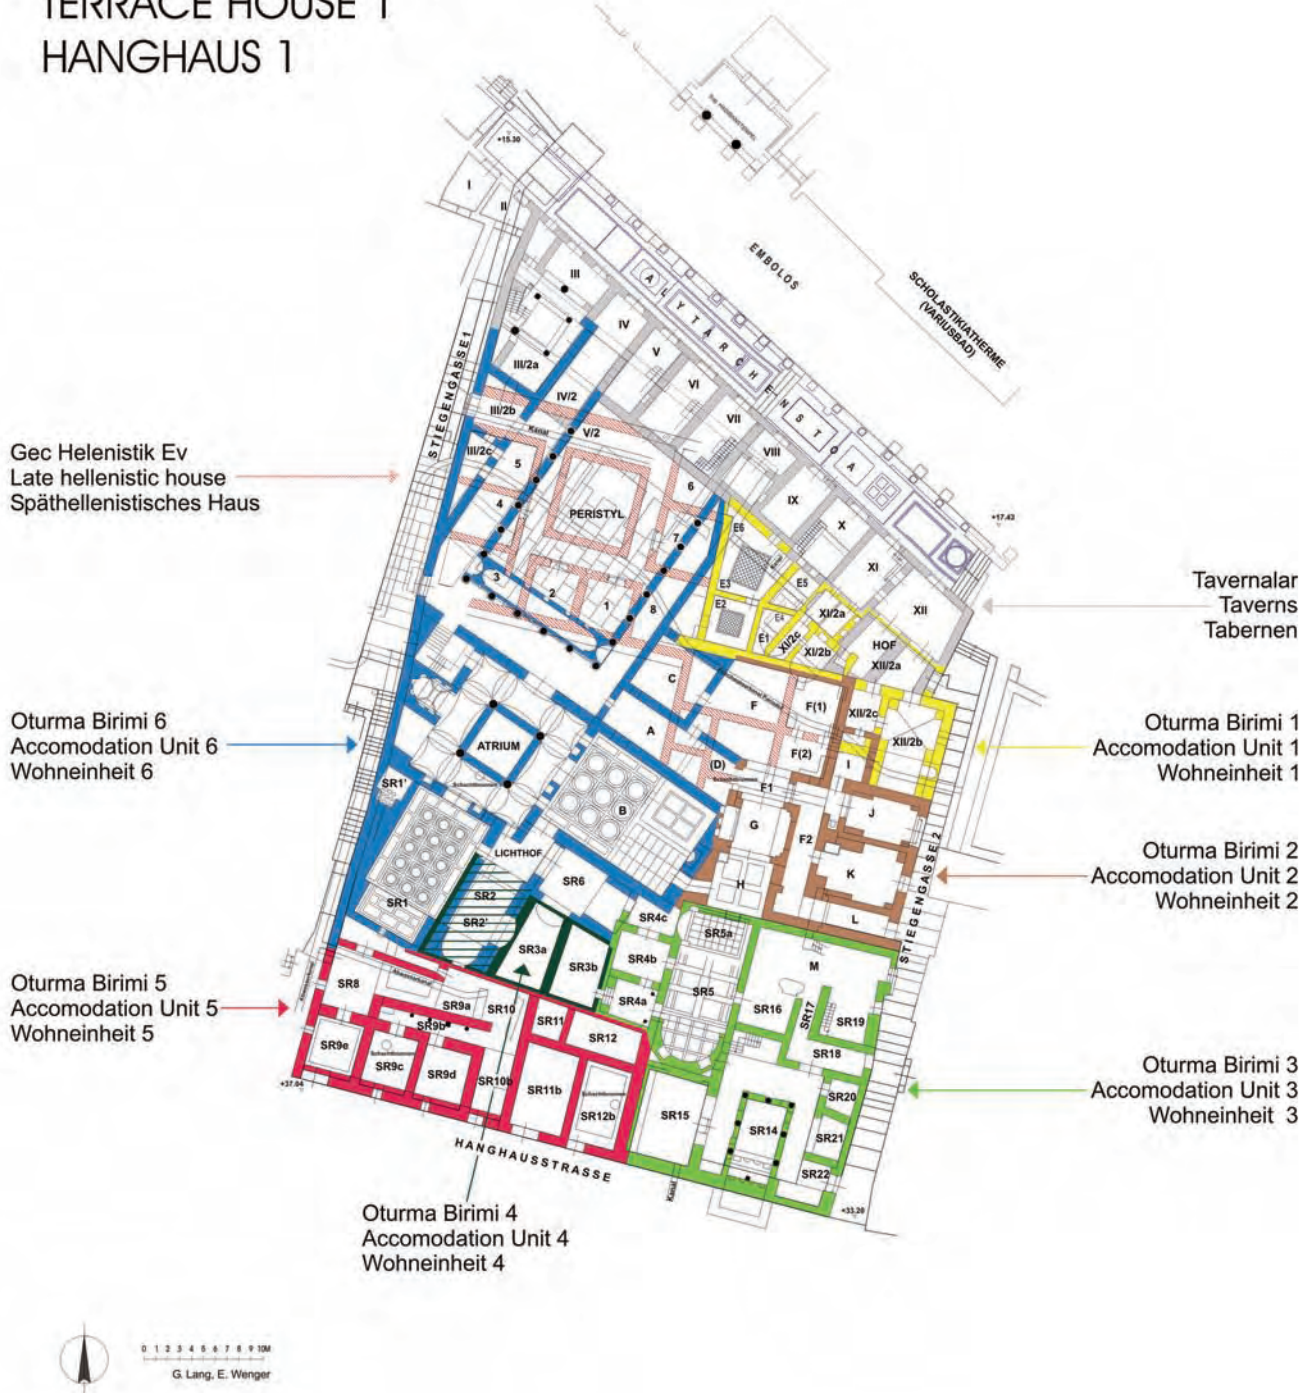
Ephesos, Hanghaus 1, Plan (G. Lang, E. Wenger)
